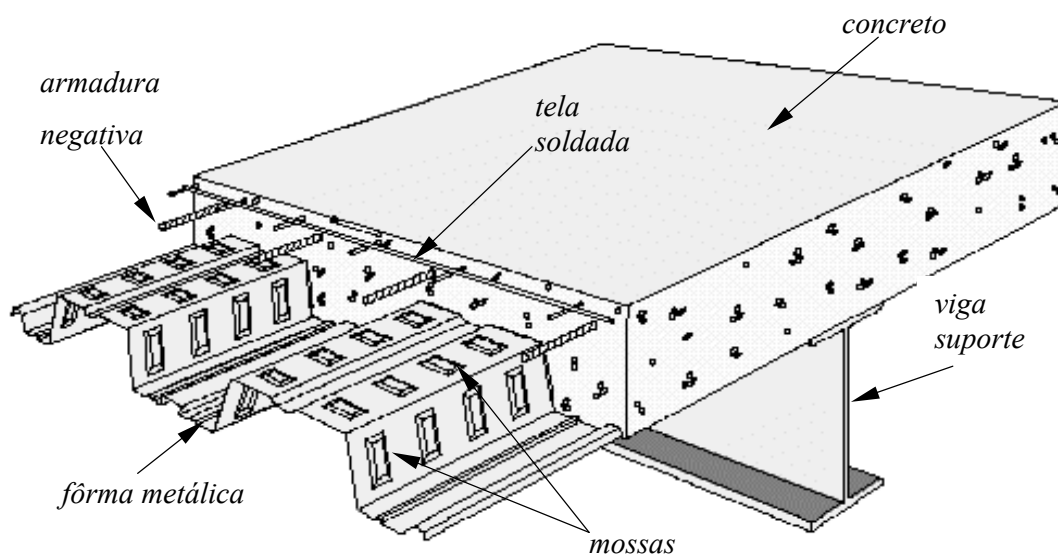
Detalhe de uma laje mista com fôrma de aço incorporada após a cura do concreto.
